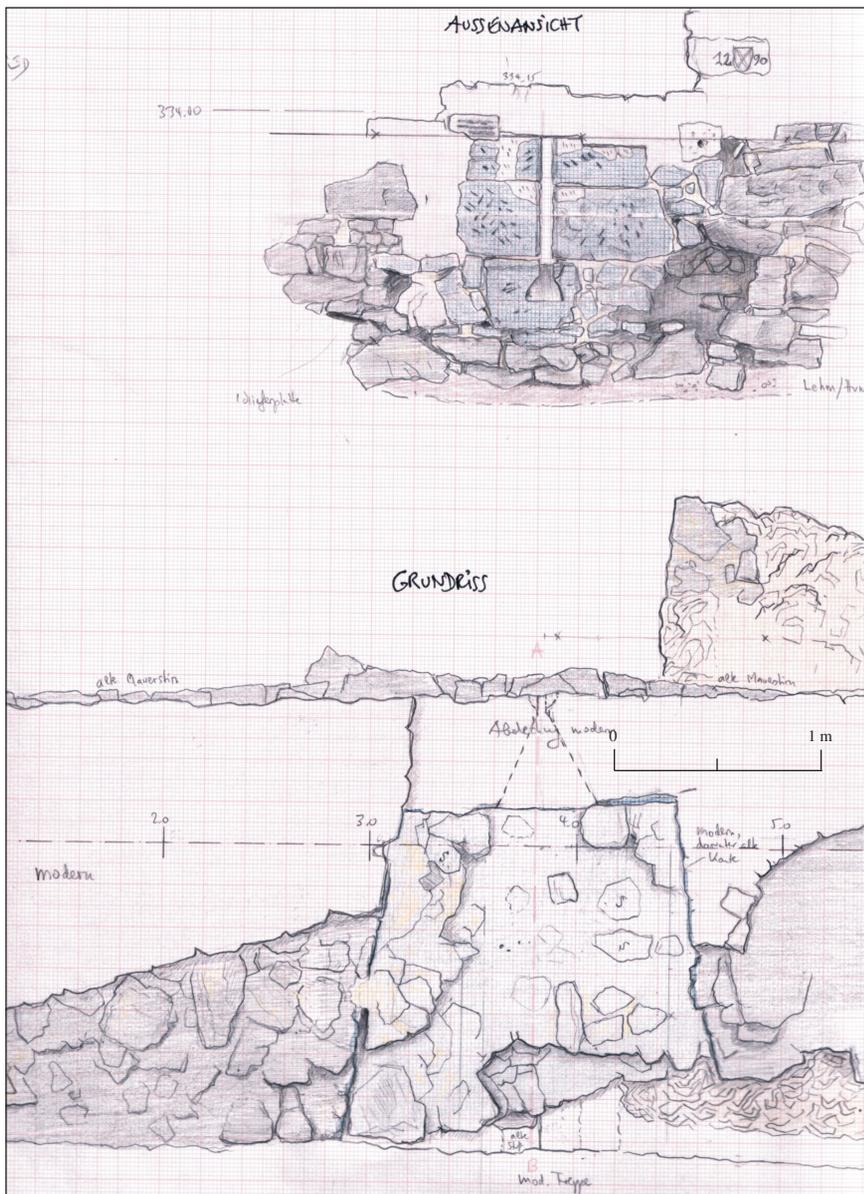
Hufeisenförmige Schießscharte, 1466 ff. eingebaut in die alte Ringmauer, modern ergänzt in den 1980er-Jahren. Außenansicht und Grundriss (Aufmaß: Verf., 2004).
